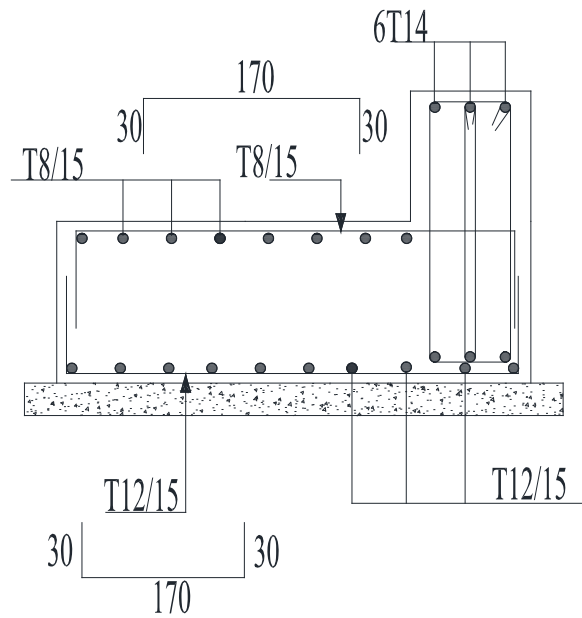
Schéma de ferrailage des semelles filante.
